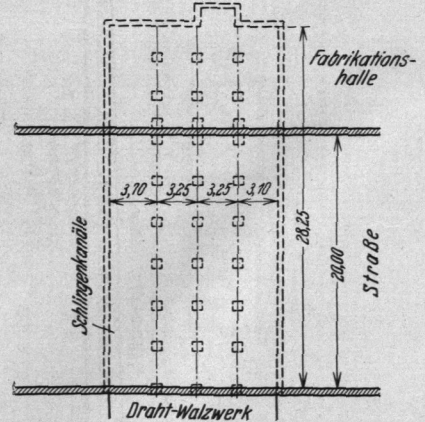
Grundrißskizze der bis unter eine benachbarte Fabrikationshalle geführten Schlingenkanäle eines Drahtwalzwerkes.
